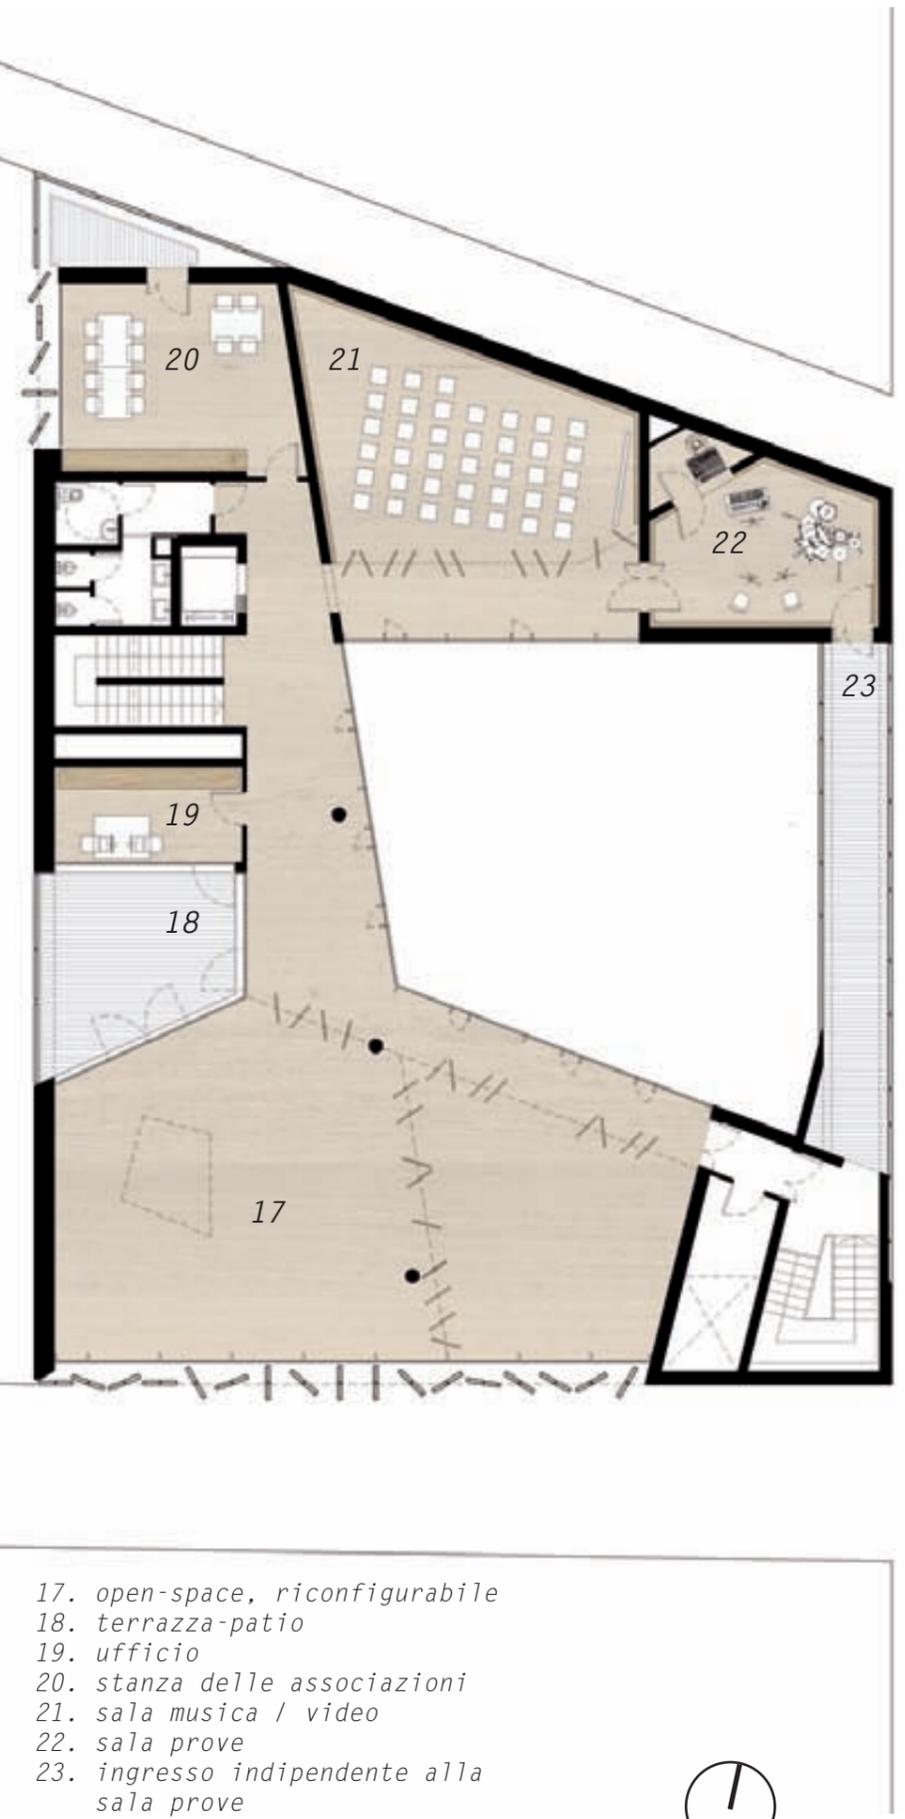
| Pianta del Piano Primo (quota: + 4.50).
